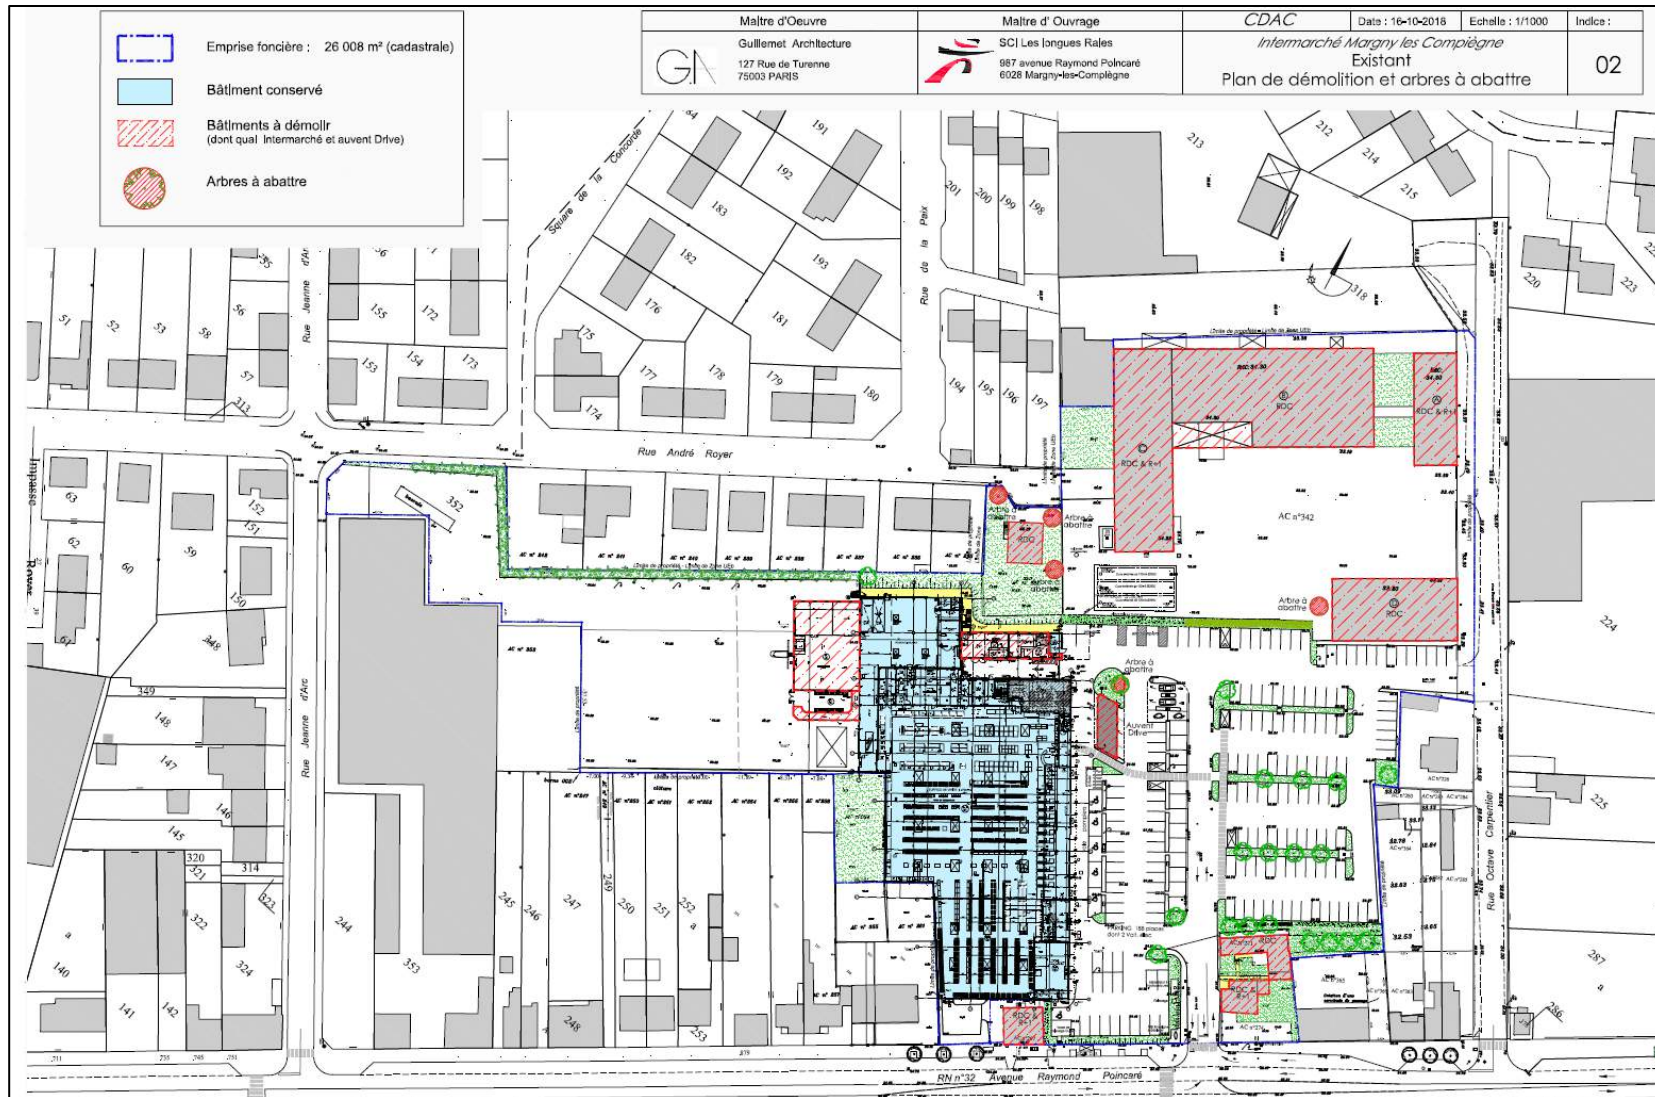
Plan des démolitions prévues (Source : Permis de Construire)
